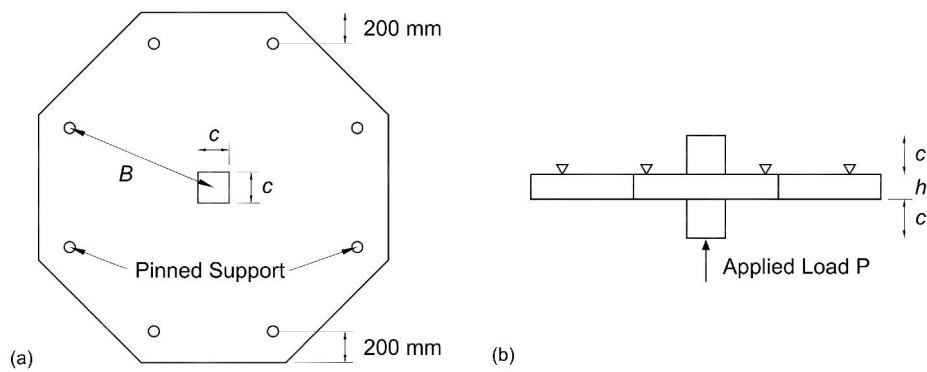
Geometria dos modelos ensaiados: (a) Vista superior; (b) Vista em alçado [8].
